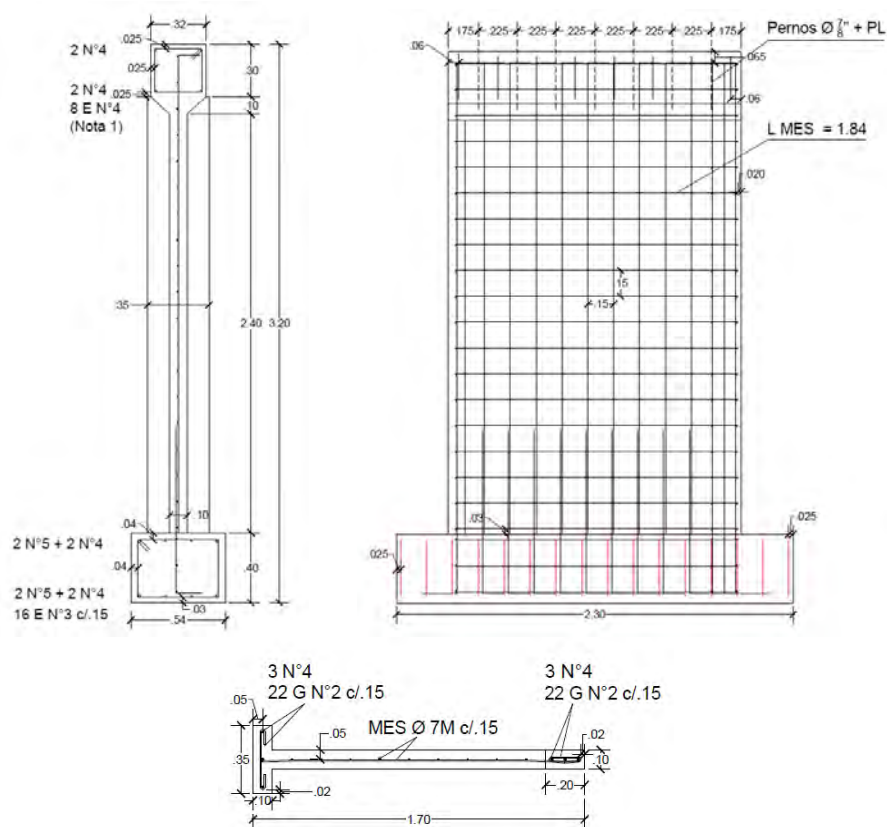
Especificaciones Probeta de MDCR: a) Vista lateral; b) Vista frontal; c) Vista en planta
